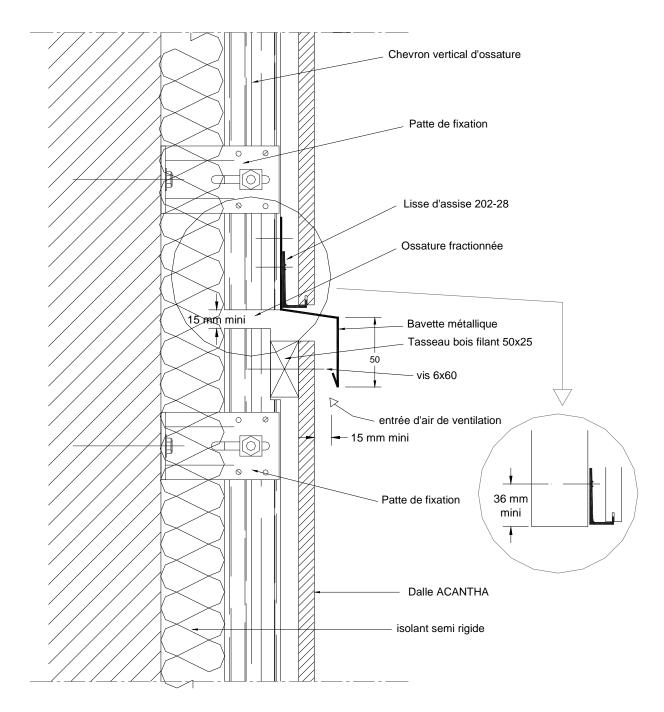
Joint horizontal de fractionnement de l'ossature (tous les 4 niveaux ou 12 m (h))
